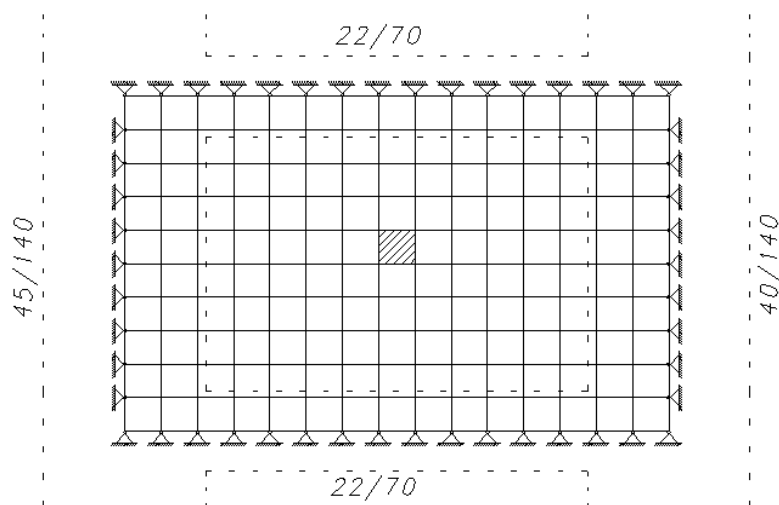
Trecho do 3º pavimento com os elementos de concreto
